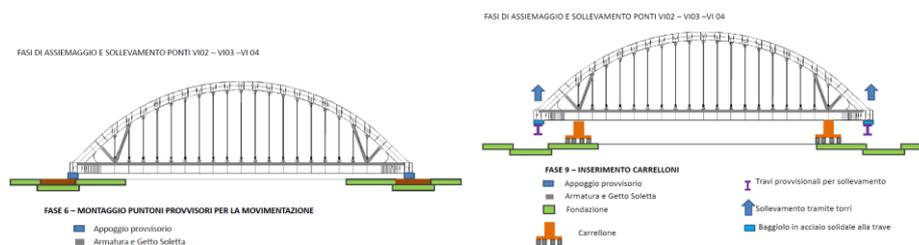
Fasi di assemblaggio e sollevamento dell'opera
